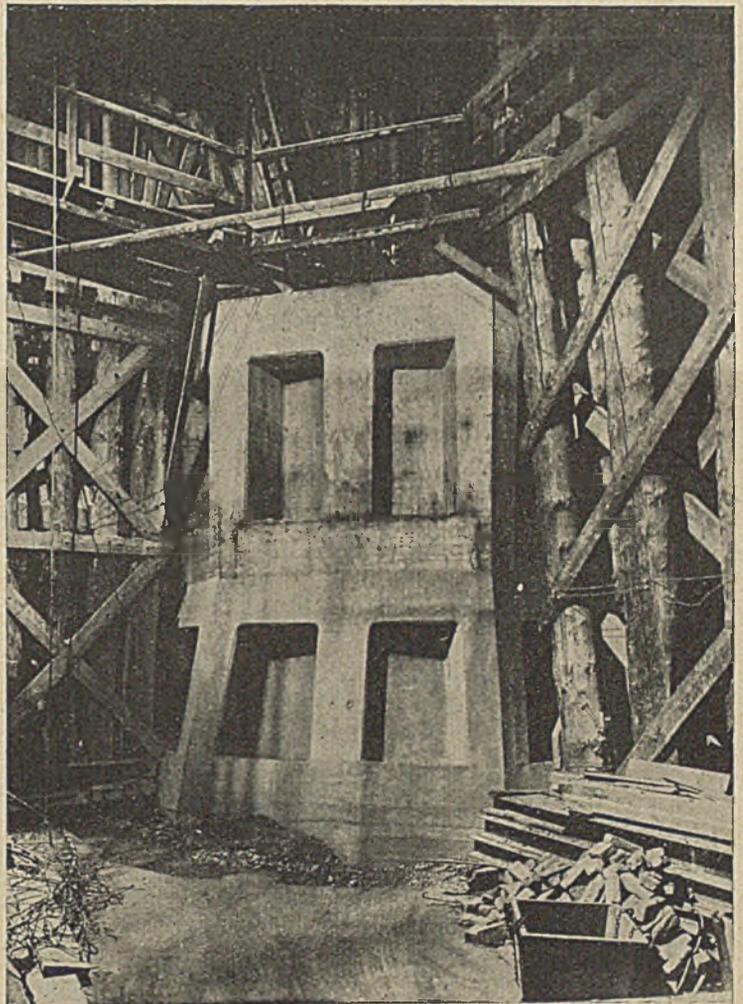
Ansicht der fertigen Eisenbeton-Ummantelung der Turmpfeiler.
